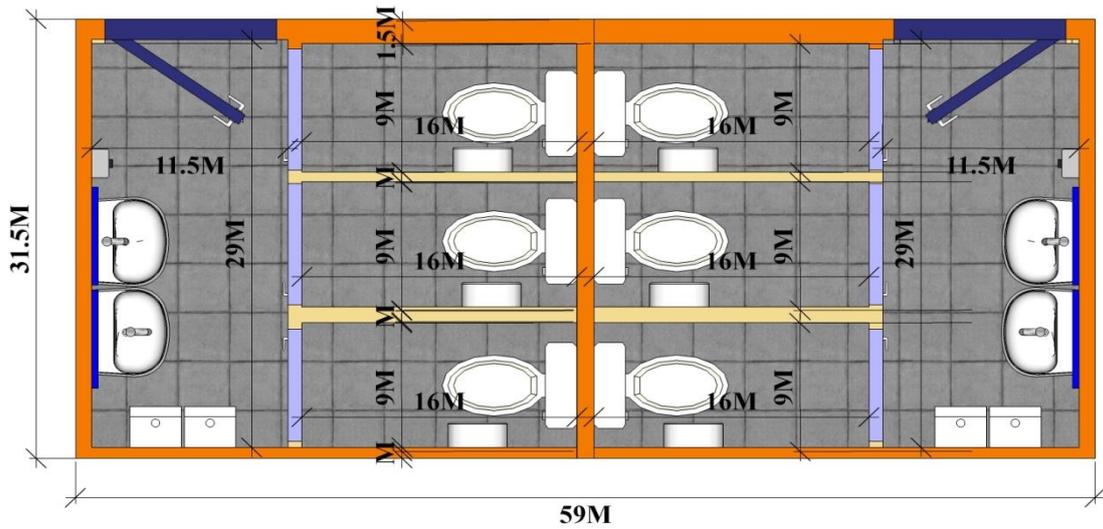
Bloc sanitaire modulaire-Vue en plan
